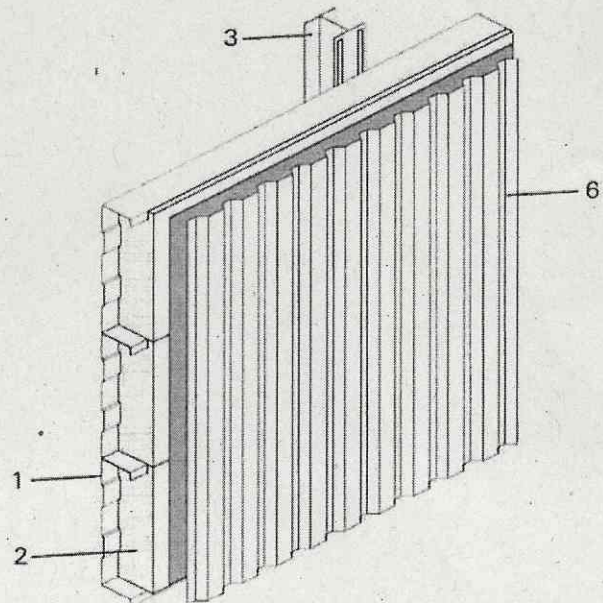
Schema des Baus einer Wand- Wände mit Fassade aus Stahlwellenblech oder Stahltrapezblech
